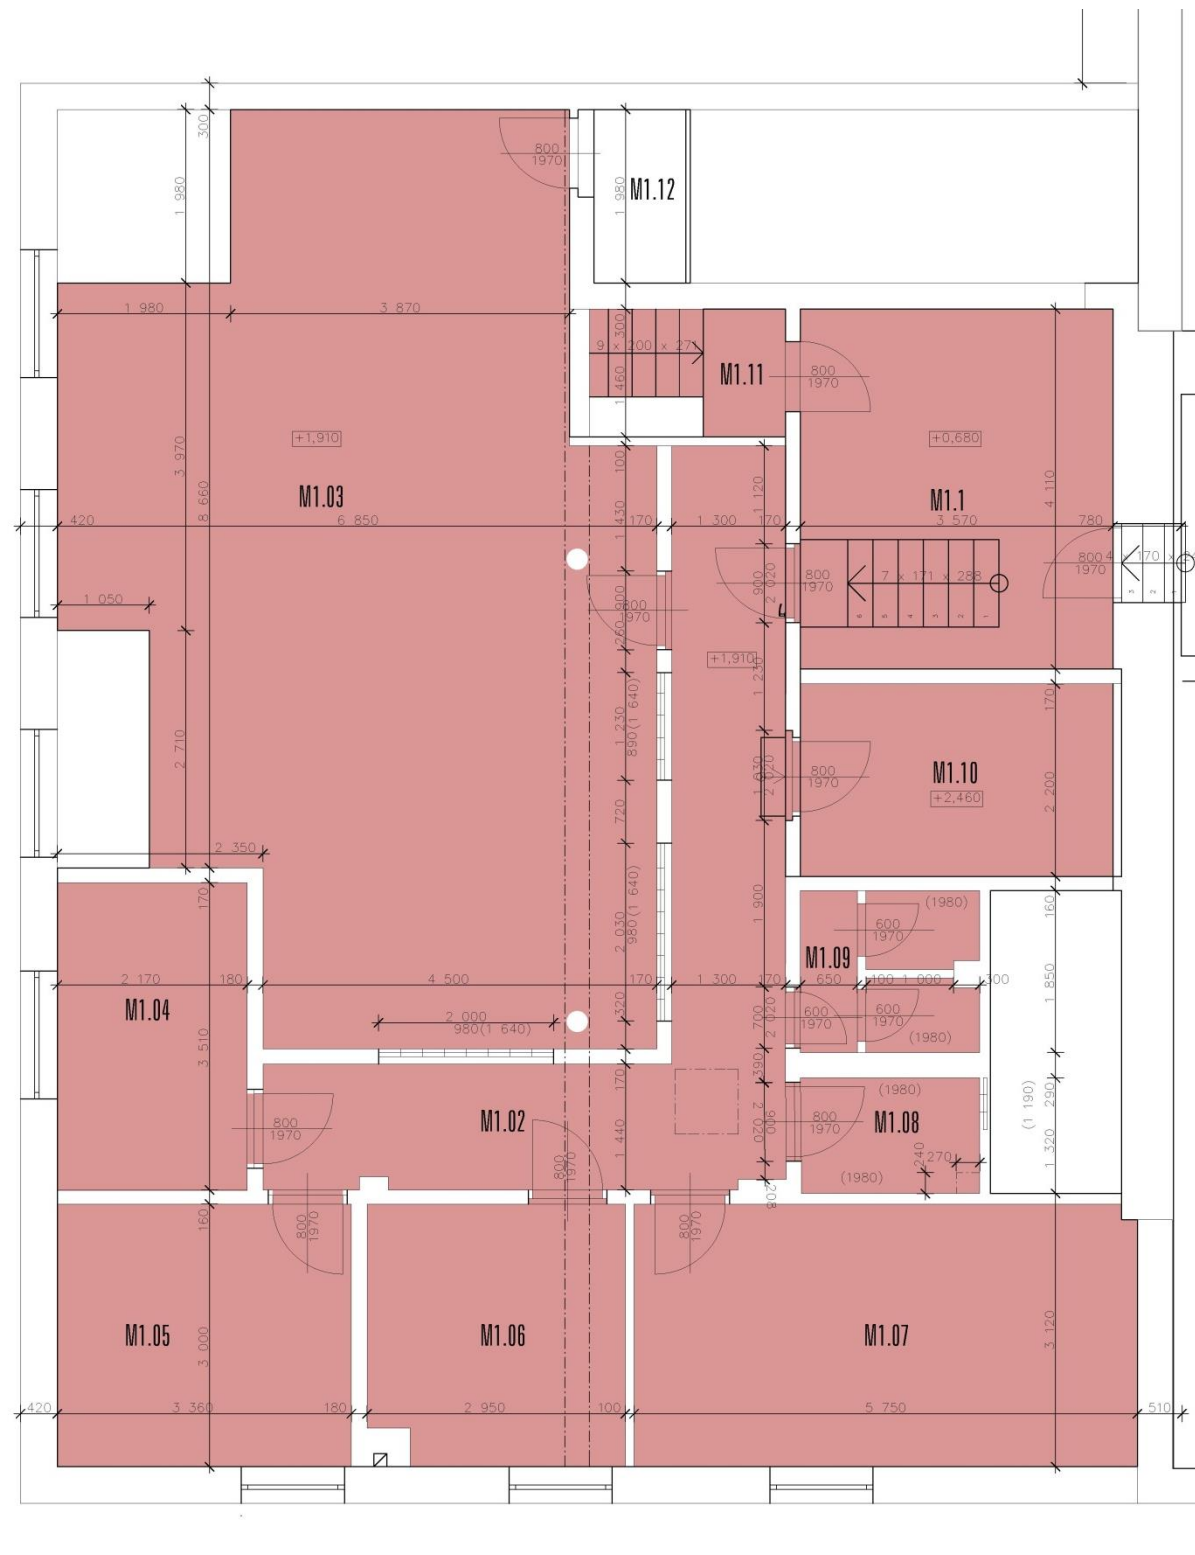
Půdorys 1. NP – stávající stav s barevným vyznačením využití jednotlivých prostor
